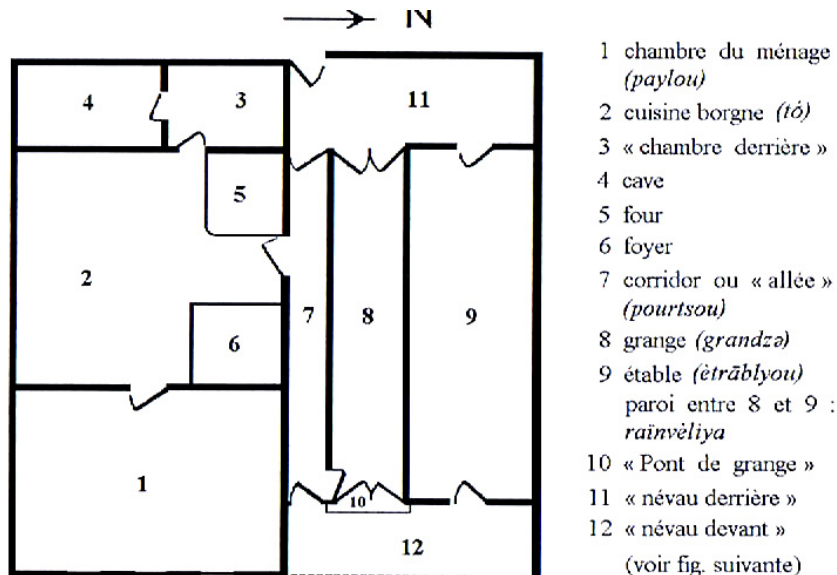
Plan d'une ferme ancienne (dimensions 20 × 20 m)
